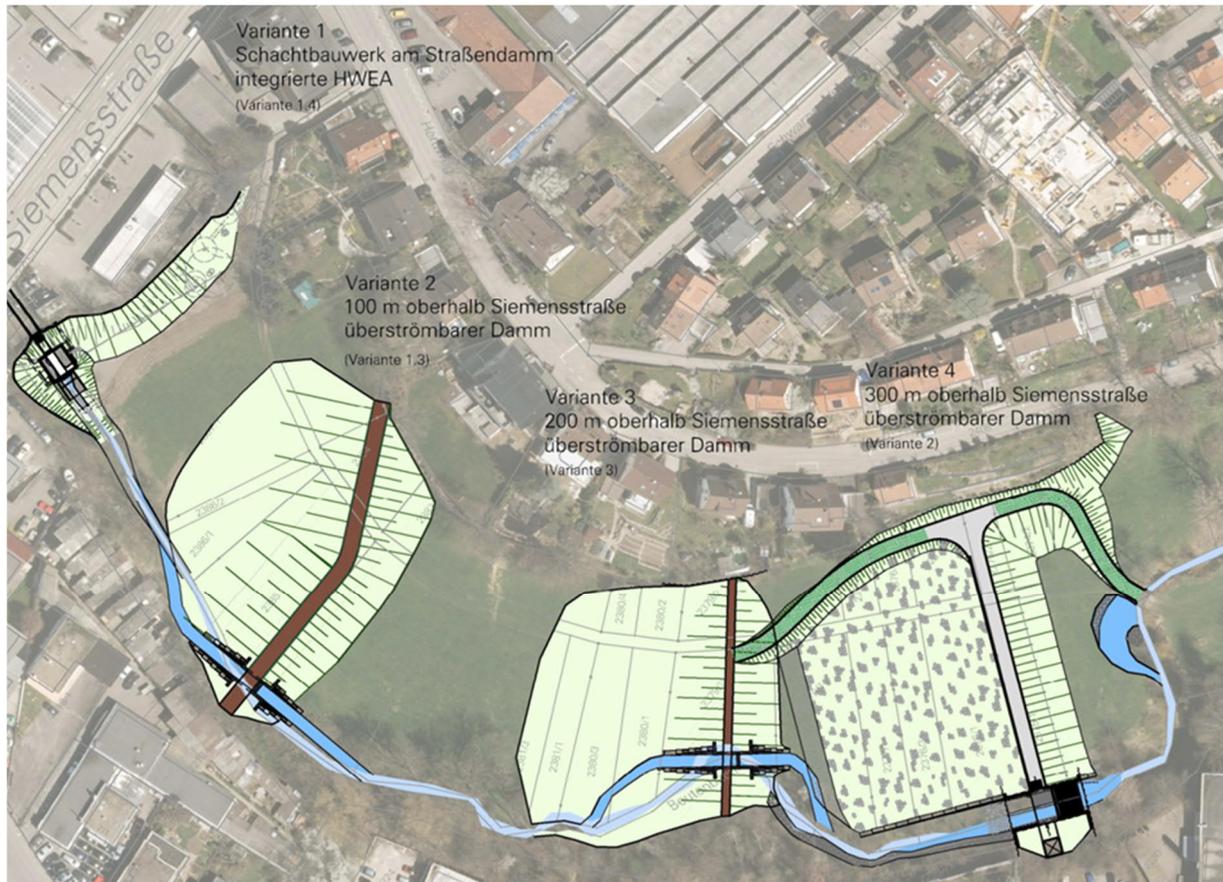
Lageplan mit den untersuchten Planungsvarianten Unteres Scheffzental
